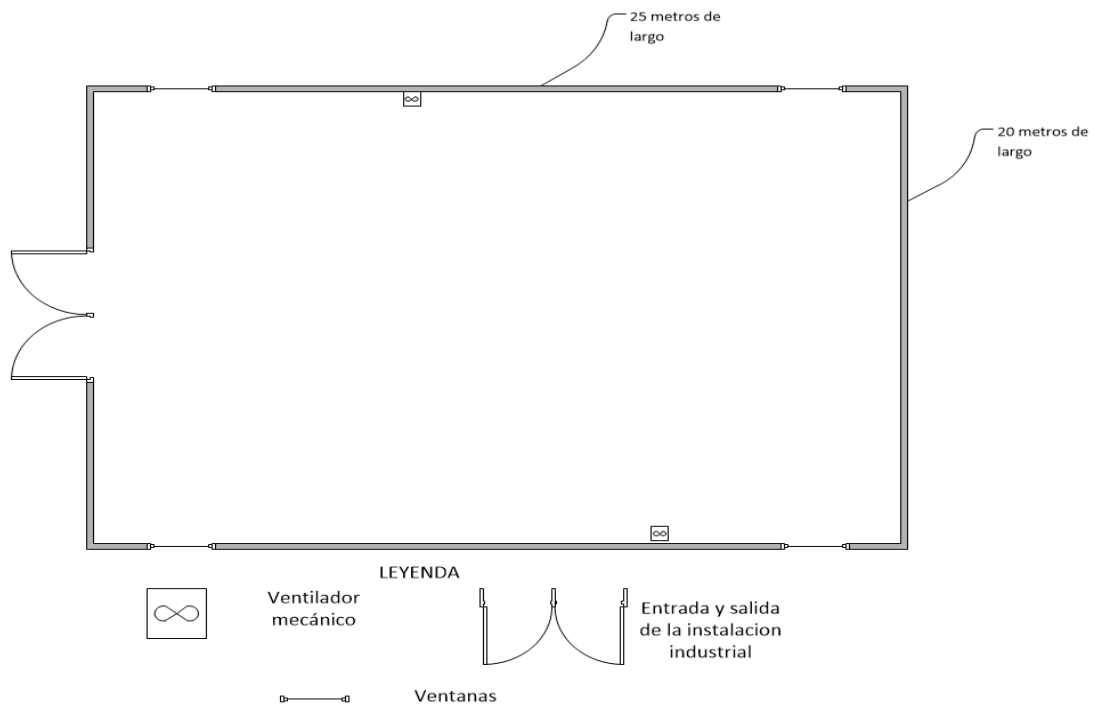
Plano de planta actual con distribución de ventiladores mecánicos
